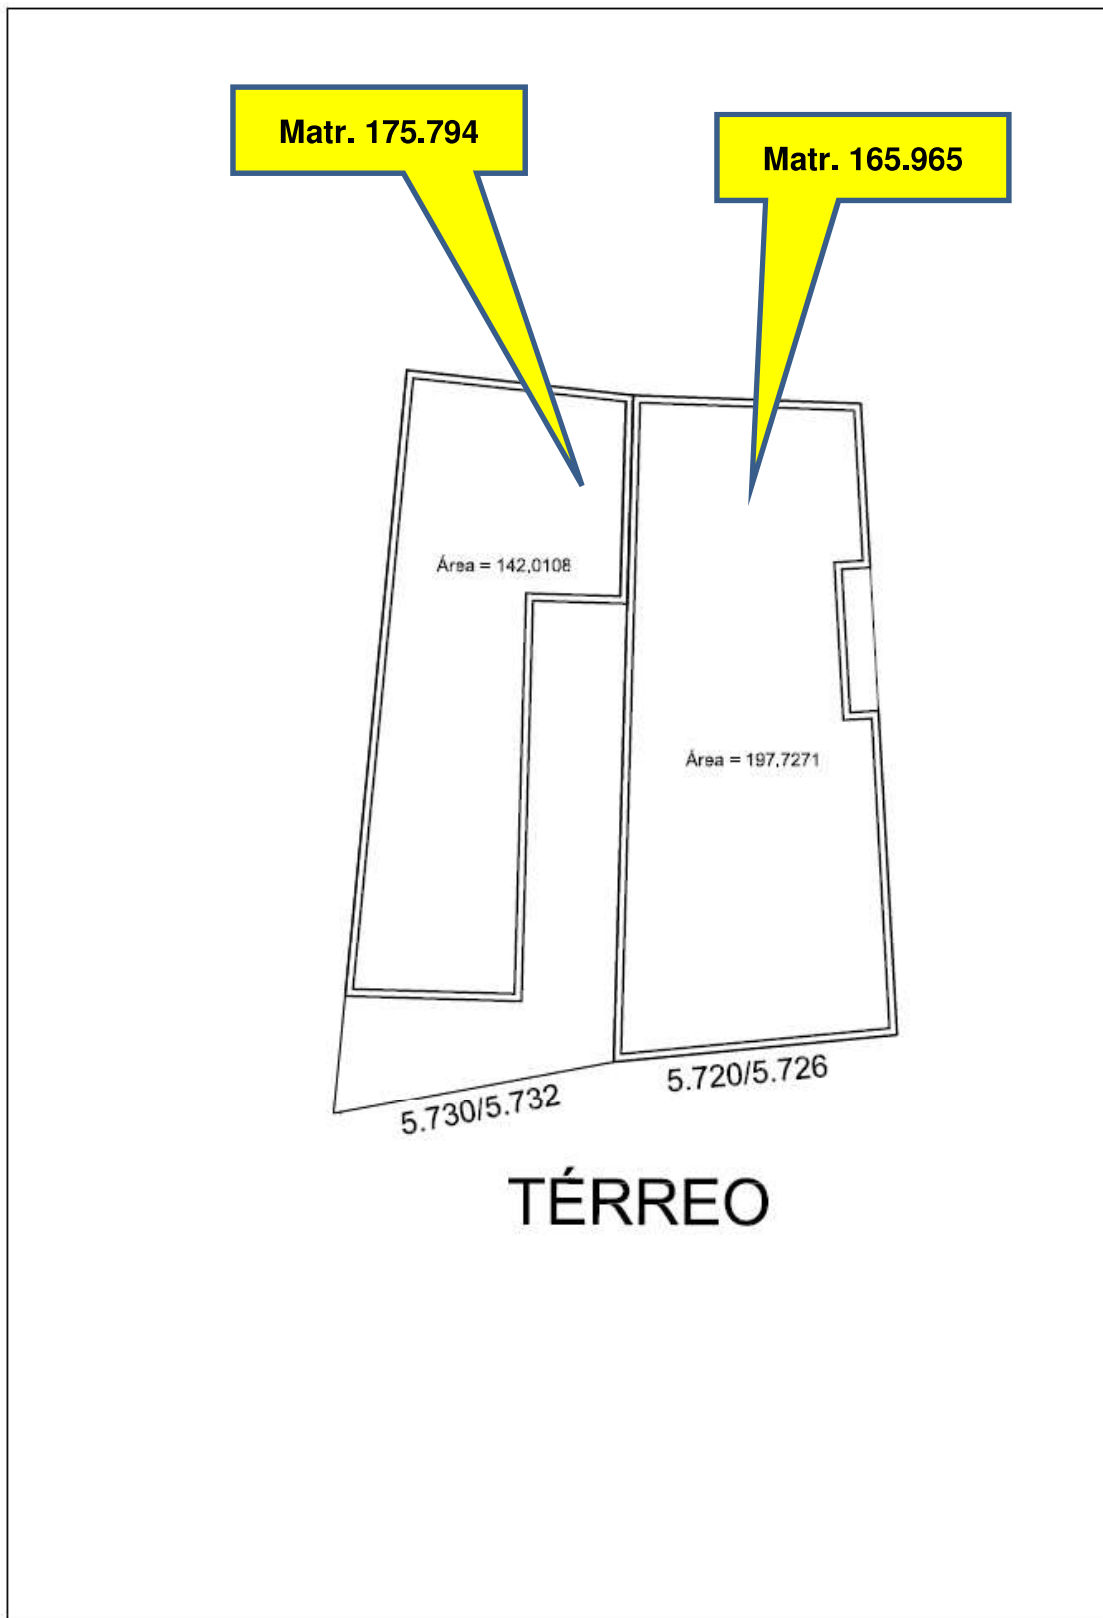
Croquis dos pavimentos térreo dos Imóveis sob Matrículas nºs 175.794 e 165.965 – 14^o CRI.
